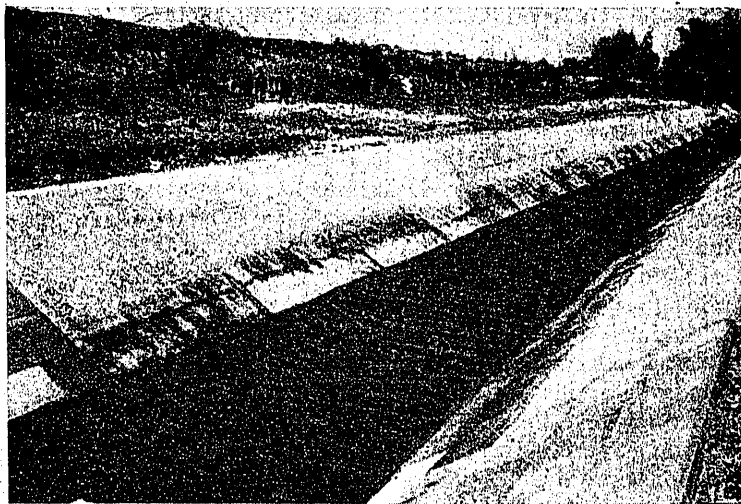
Vista de conjunto después de terminadas las obras (tipo *D*).
